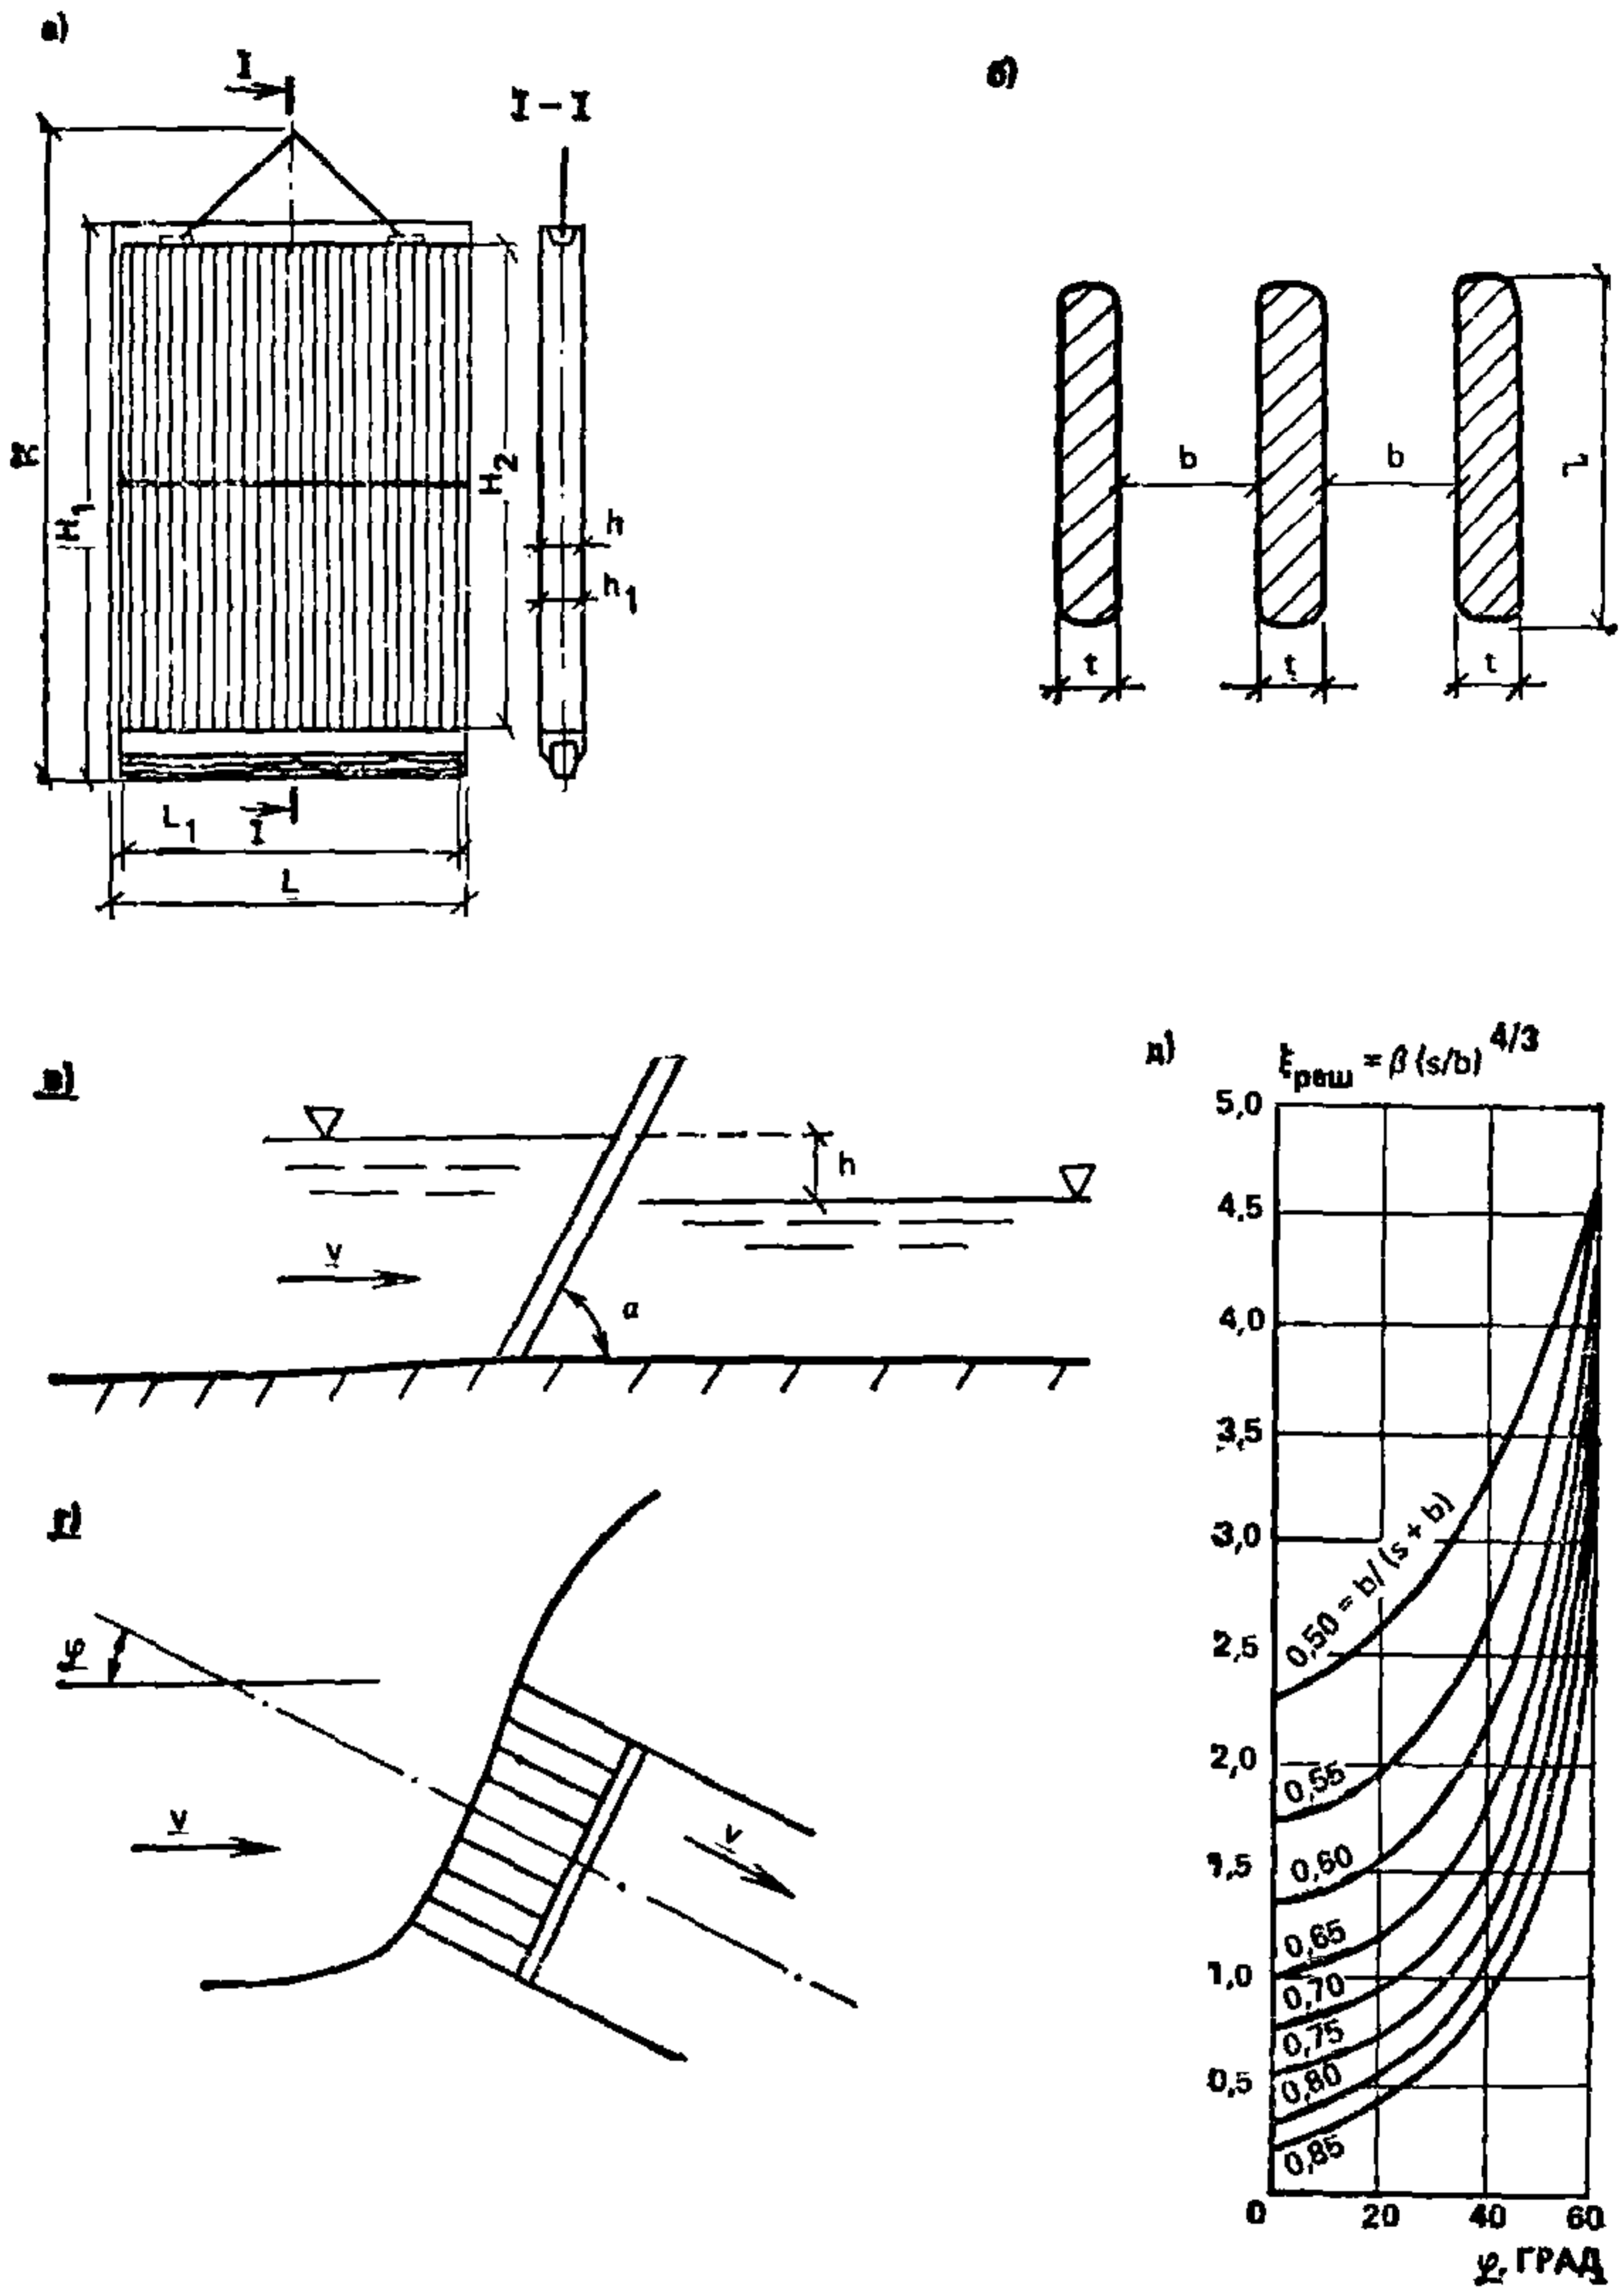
Сороудерживающая решетка и схема установки устройства в потоке
